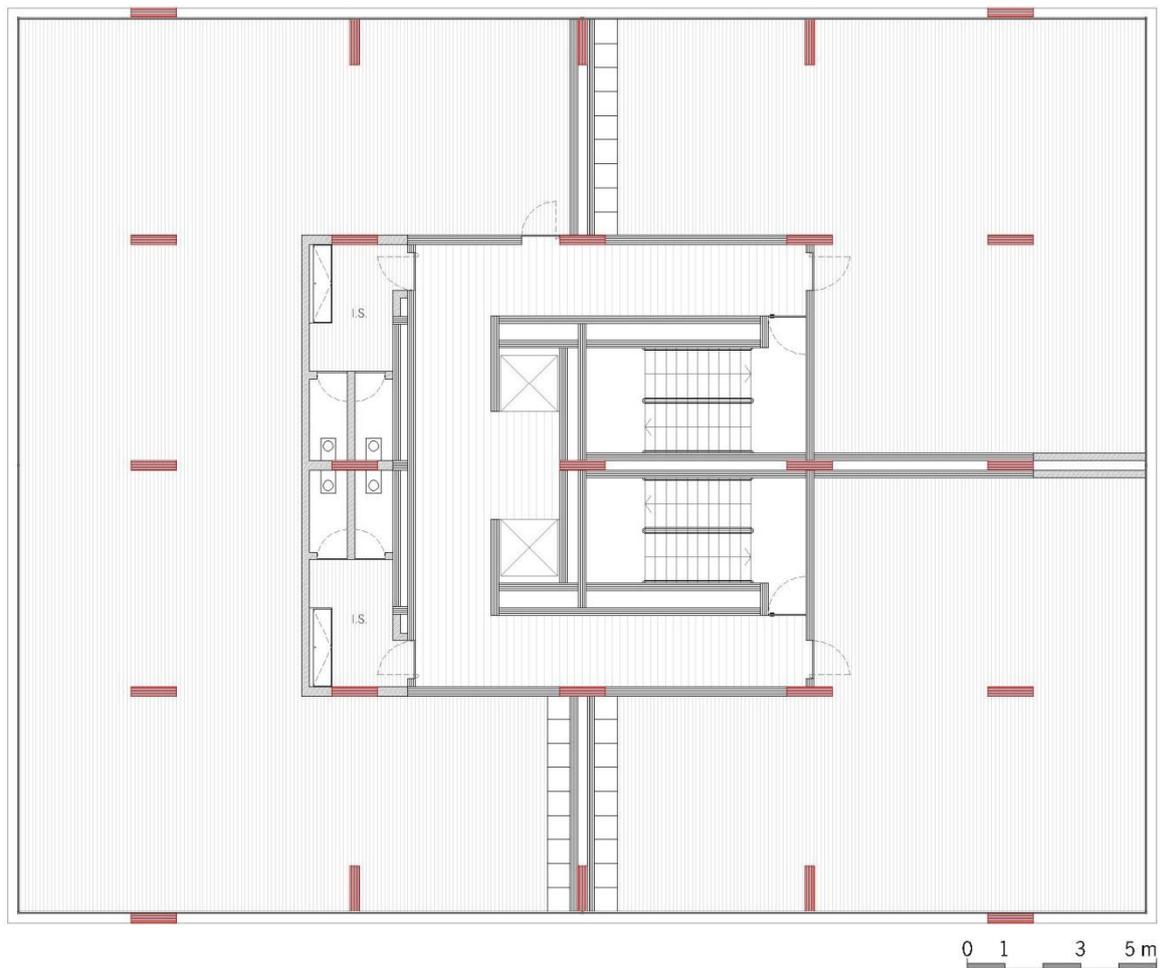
Planta Tipo para Utilização do Tipo Escritórios
